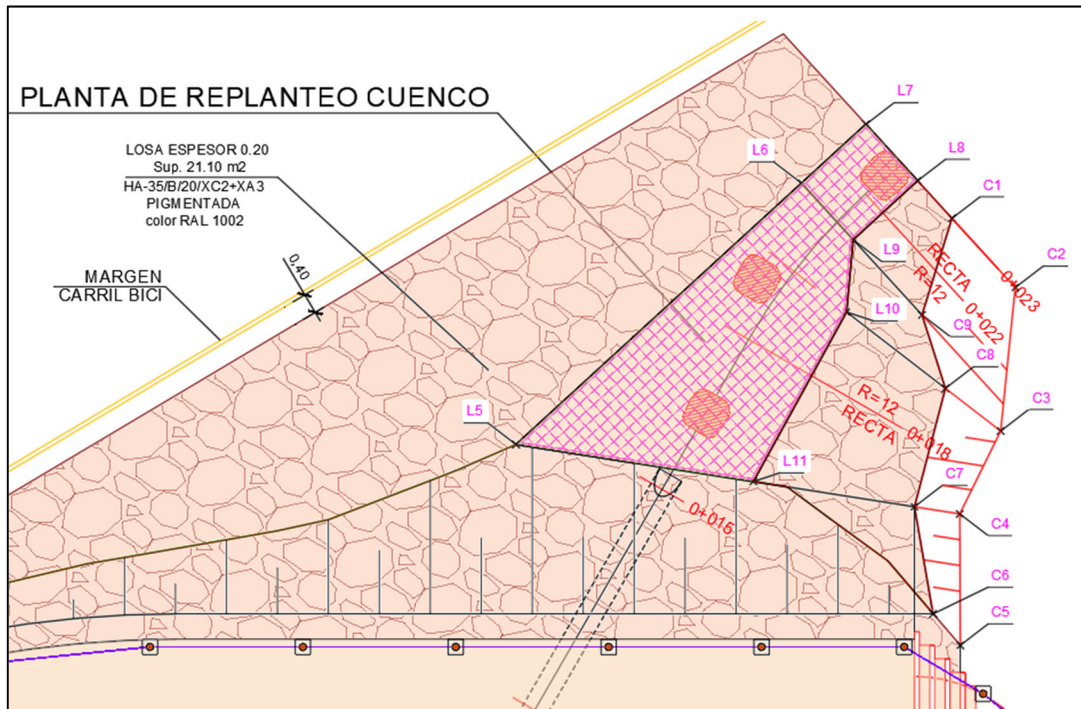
Planta de replanteo del cuenco amortiguador.
